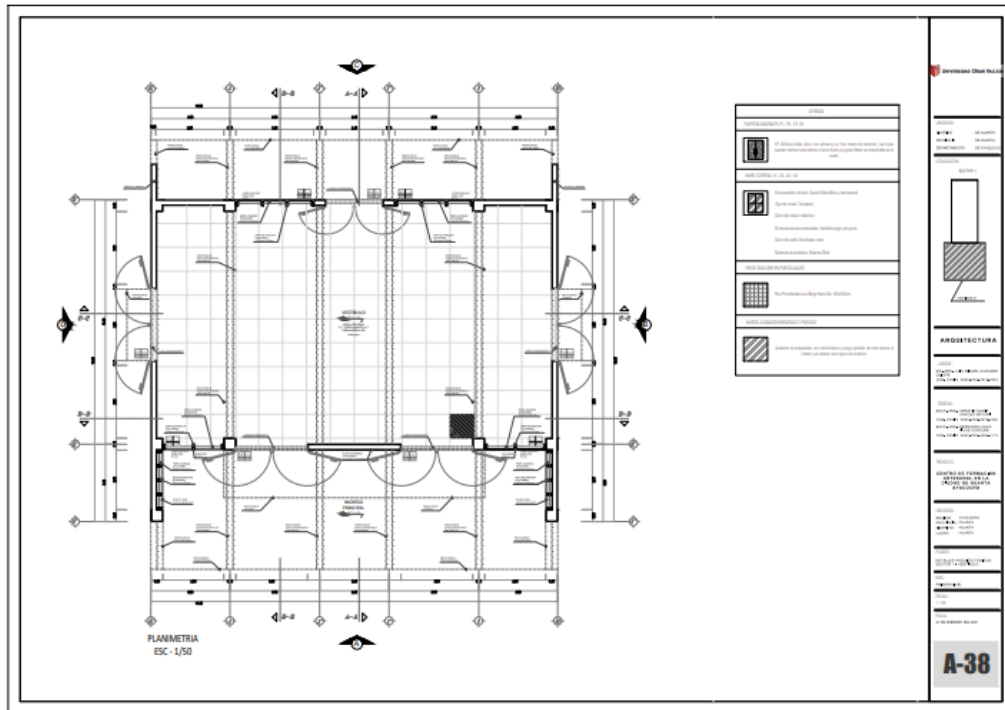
Detalles arquitectónicos por sectores escala 1/50.
